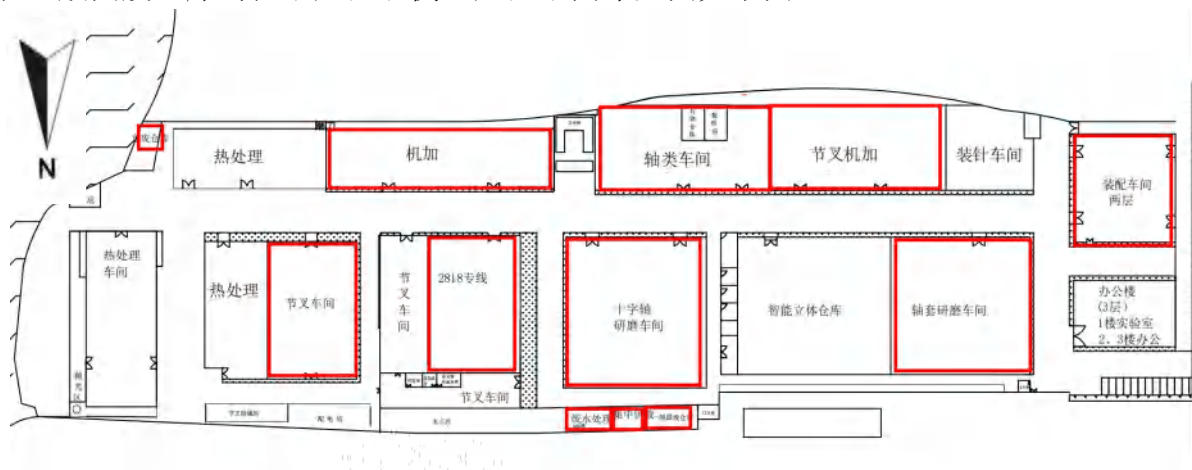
厂区平面布置图（标红为本次项目涉及车间单元）
